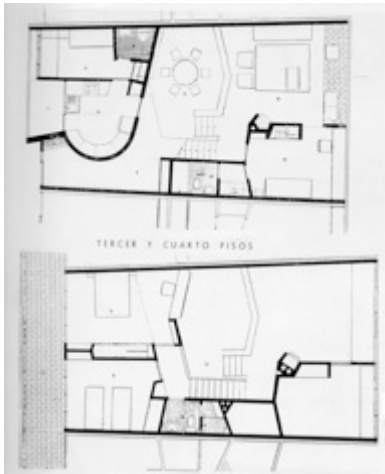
Plantas de Dúplex piso 3 y 4. Bloque B1.
